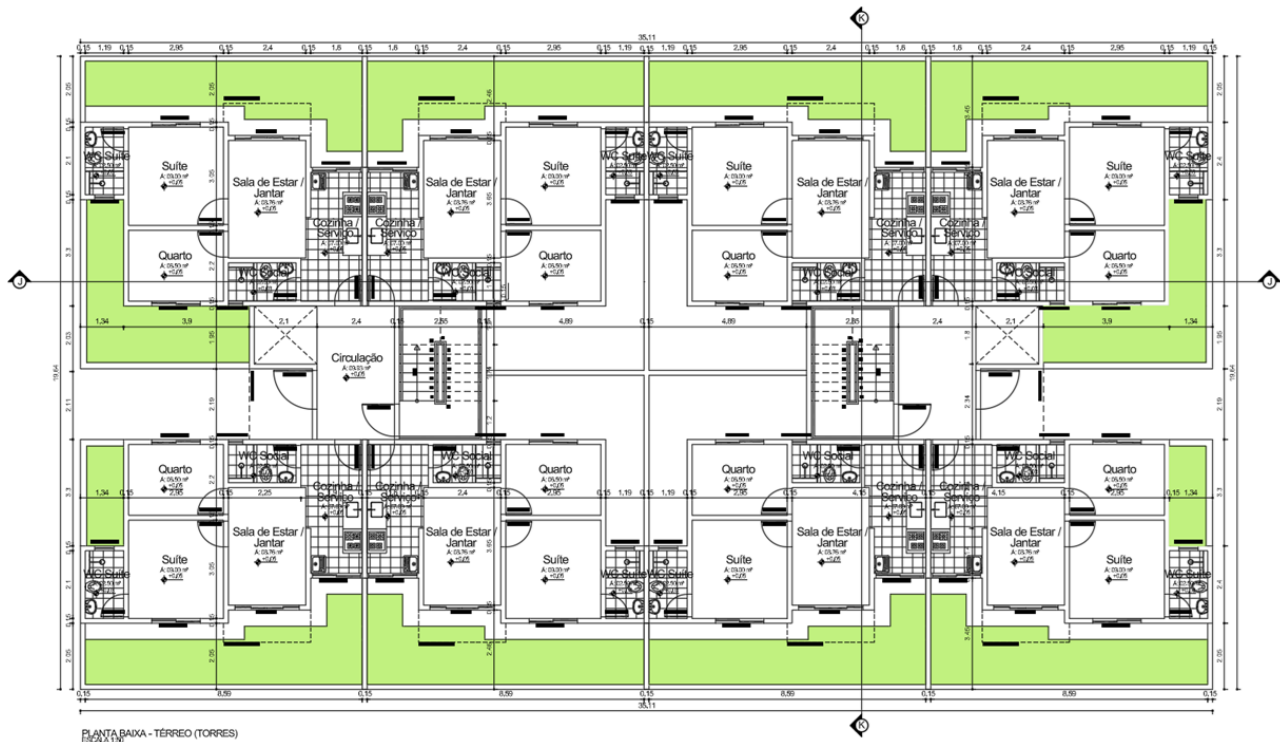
Planta dos apartamentos. Fonte: LM5 Construtora. Planta de Cobertura
